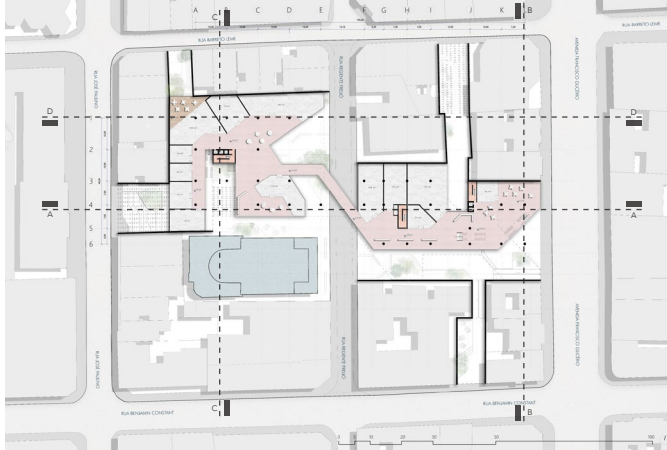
Planta do primeiro pavimento (galeria) / Fonte: Autoria do grupo
